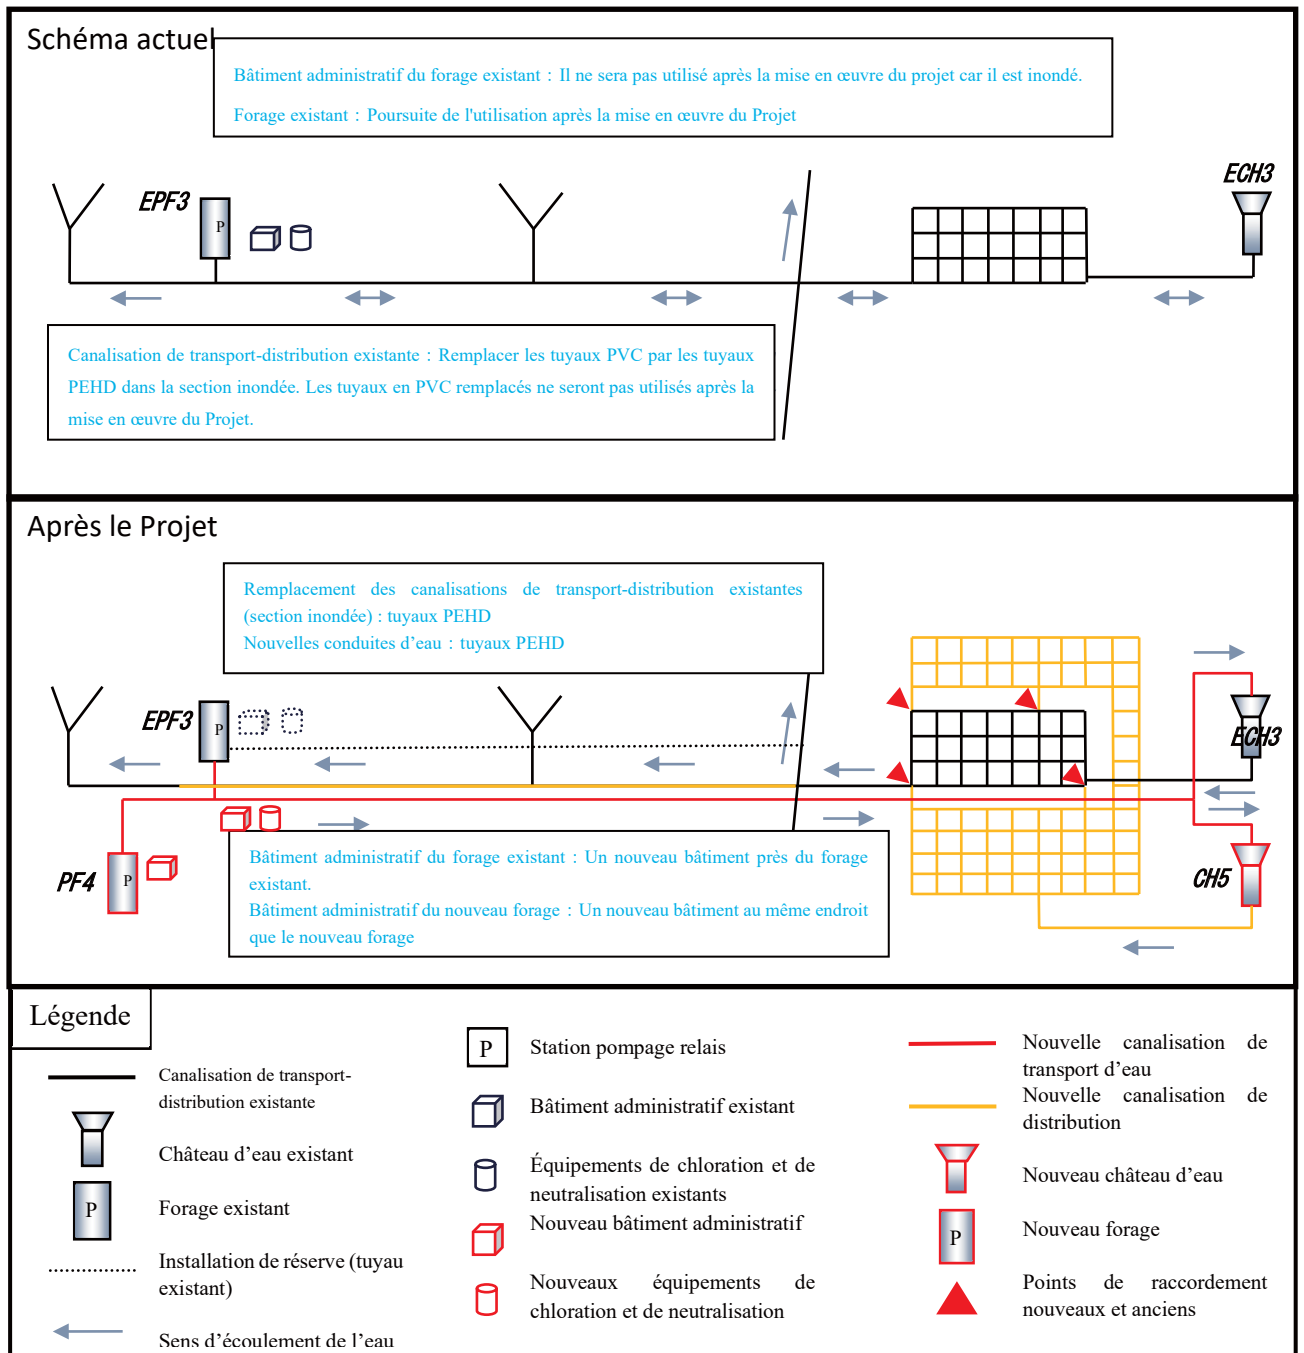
Schéma des installations dans la section Dogbo
